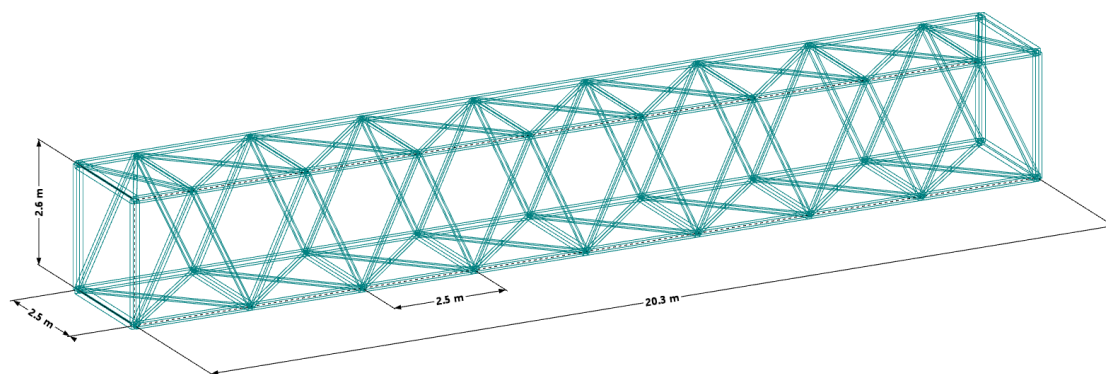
identifica os perfis do sistema estrutural da passarela metálica treliçada que possui perfis tubulares de 101 mm x 8,0 mm para os elementos longitudinais do banzo superior e perfis tubulares de 101 mm x 5,8 mm para os elementos longitudinais do banzo inferior. O travamento transversal dos banzos são constituídos por perfis tubulares de 60,5 mm x 5,5 mm e para sustentação do piso em steel deck são adotados perfis W150 x 18. As diagonais da passarela metálica treliçada tem perfis tubulares de 73 mm x 5,0 mm e próximo as torres de acesso da passarela são utilizados perfis tubulares de 101 mm x 5,8 mm. Nas extremidades da passarela são adotados perfis retangulares tubulares de 127 mm x 127 mm x 9,5 mm.
